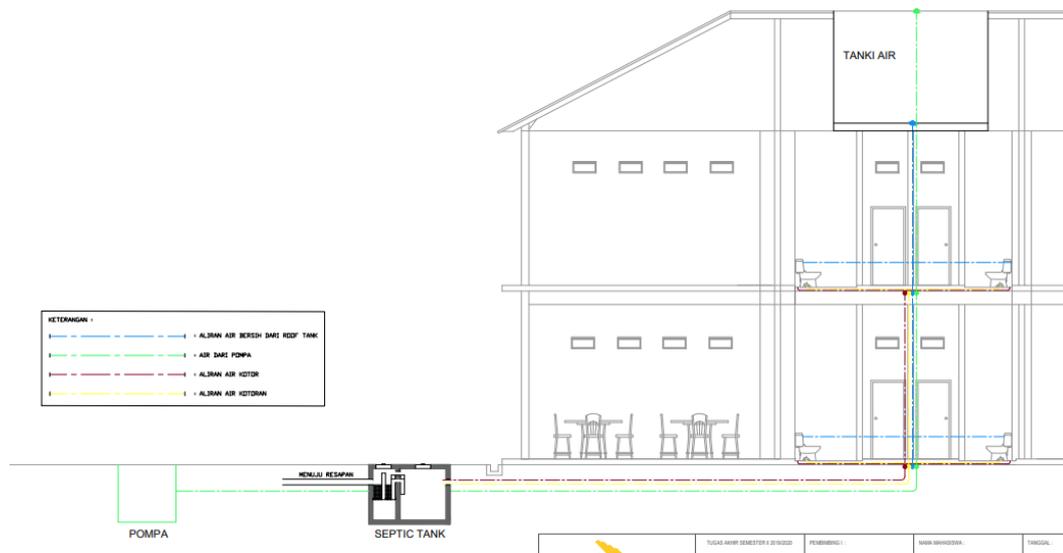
Potongan Prinsip Bangunan PKM ITERA
